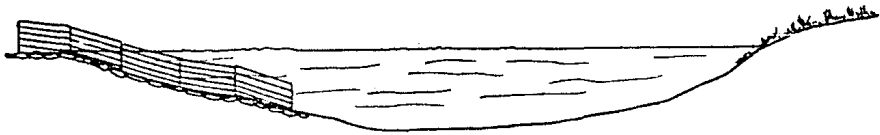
/2: Vista lateral de un abrebadero con cercado de protección y rampa empedrada de acceso para los animales. (corresponde al corte en la figura 7.1.2-12)
